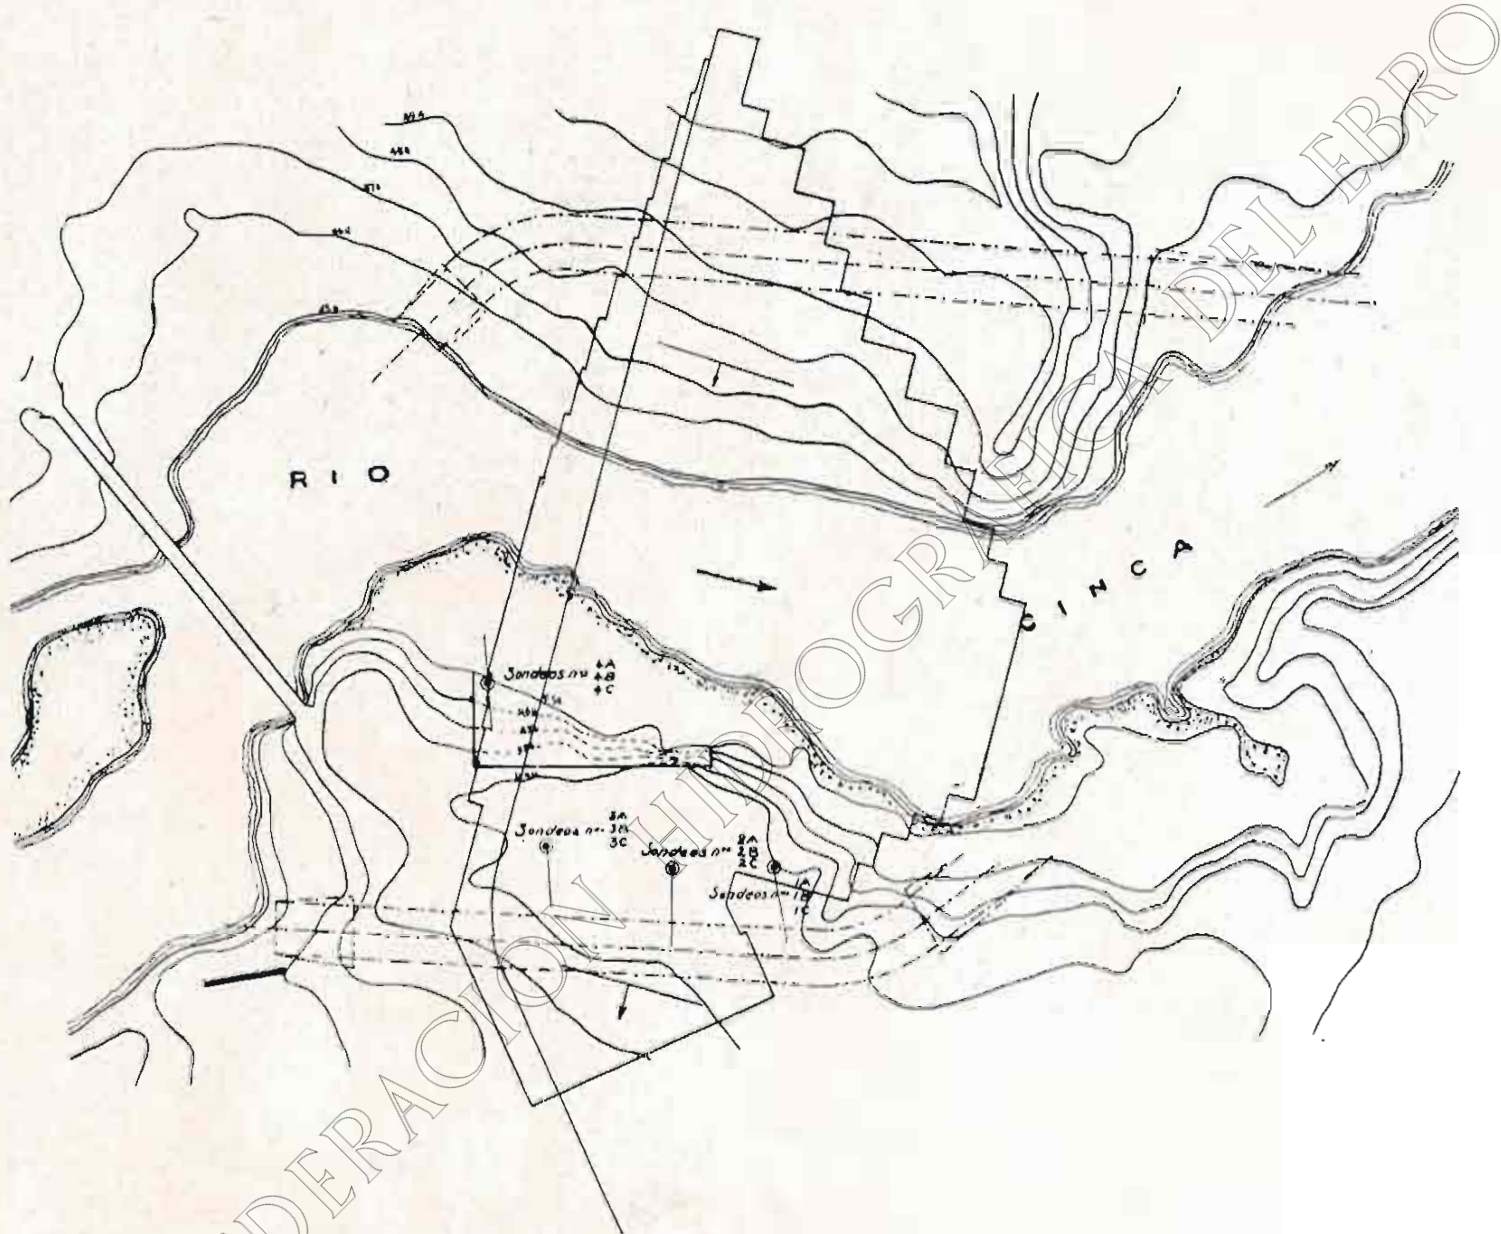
PLANTA DEL EMPLAZAMIENTO DE LA PRESA, CON LOS SONDEOS ERIGIDOS EN EL ESTRECHO DESCRITO
